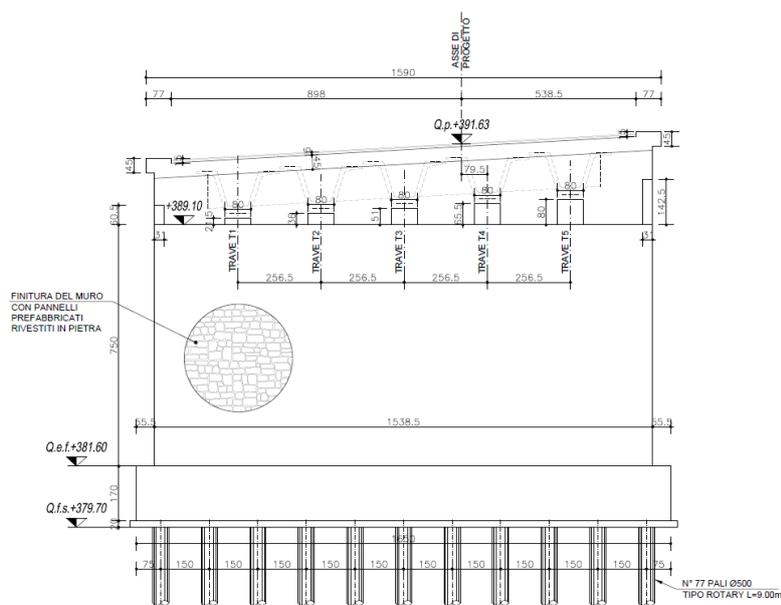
VISTA FRONTALE SPALLA SP1 VIADOTTO FOSSO BRILLÌ
